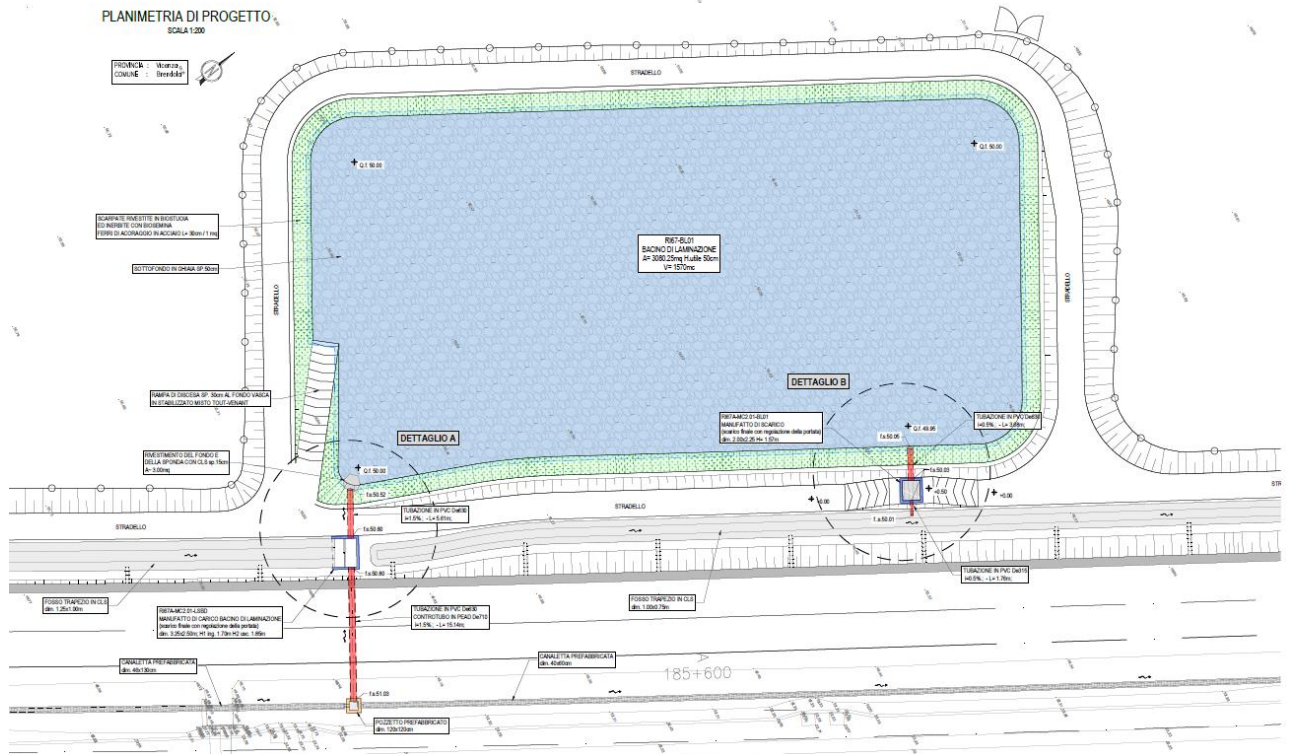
Planimetria di progetto del bacino di laminazione RI67A-BL01
